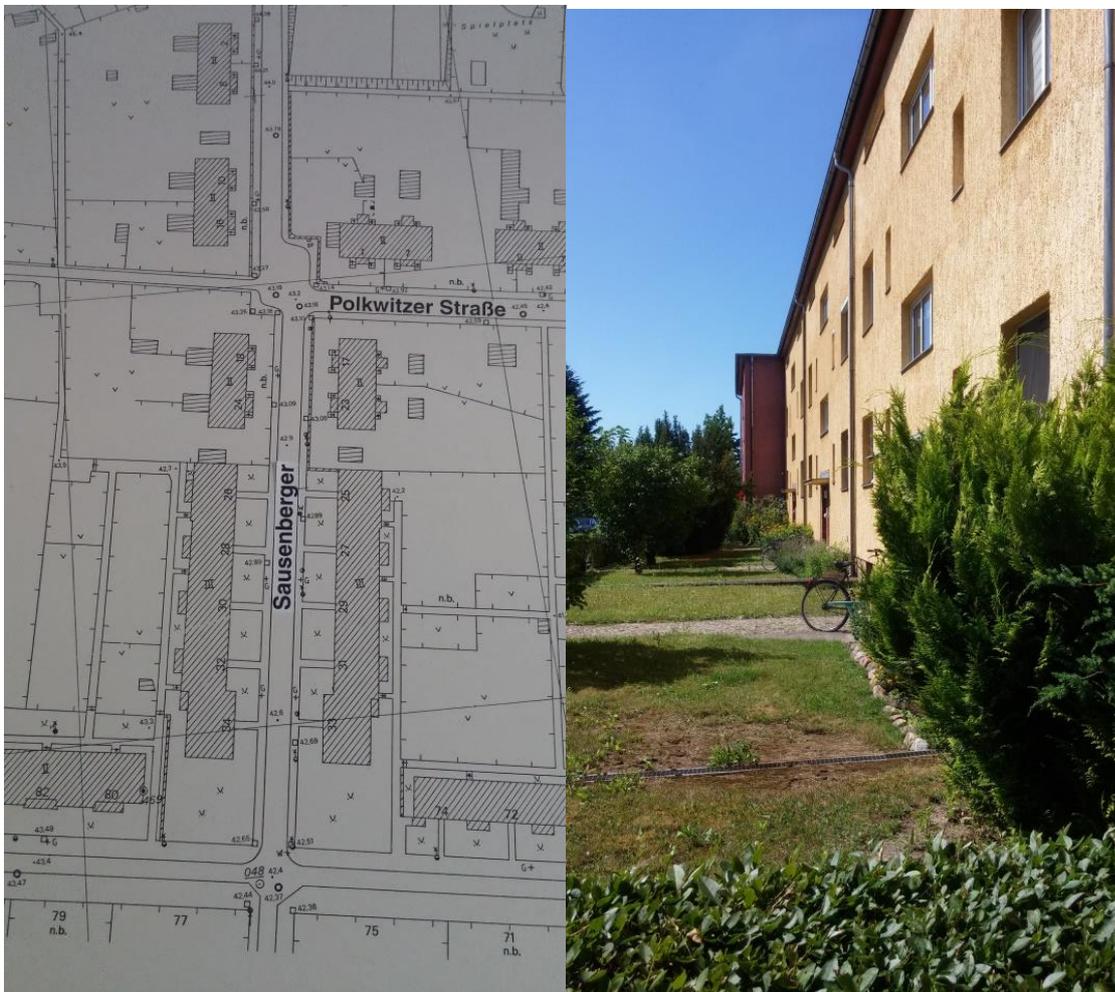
Lageplan (links) und Wohngebäude (rechts)
